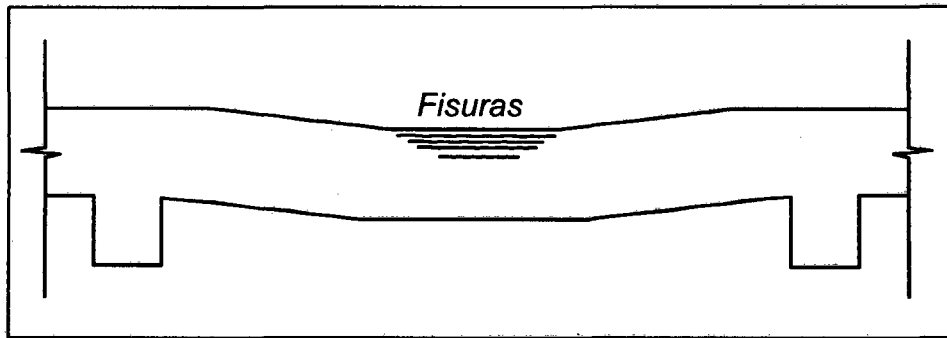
Fisuración por compresión en vigas (Pérez 2008).
